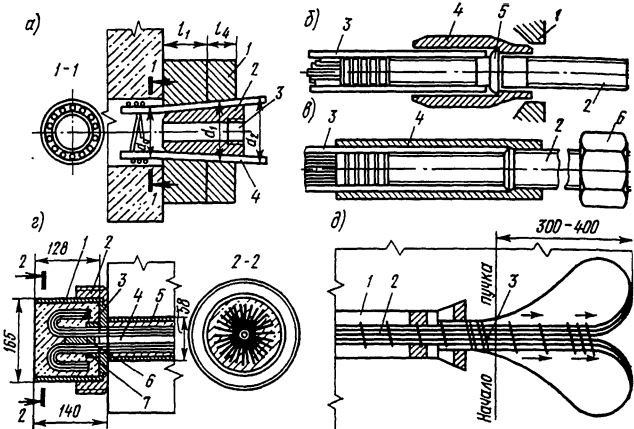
Анкеры для закрепления пучковой арматуры в напряженно-армированных конструкциях
